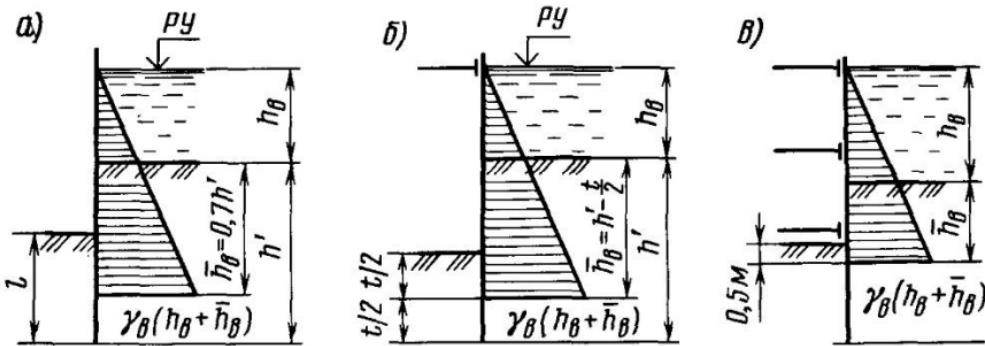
Схемы для определения глубины проникания воды между шпунтовой стенкой и водонепроницаемым грунтом:
